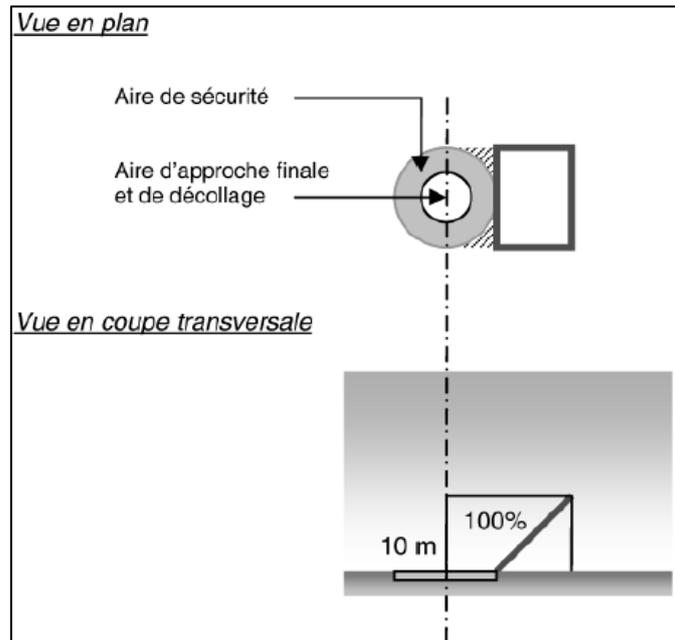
Dimensions et positionnement des surfaces latérales
